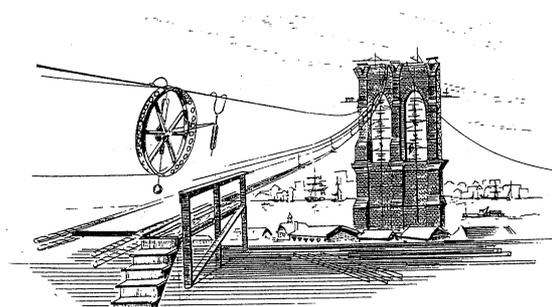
Brooklyn 橋のエアスピニング施工状況
